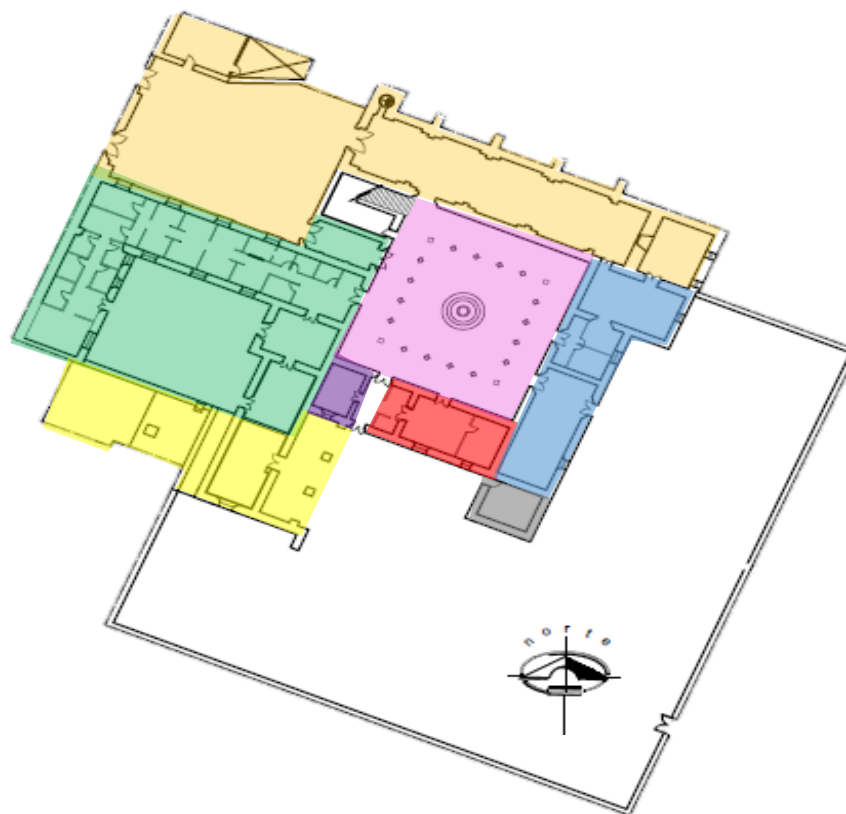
Esquema de distribución de planta baja del Ex Hospital de San Juan de Dios
